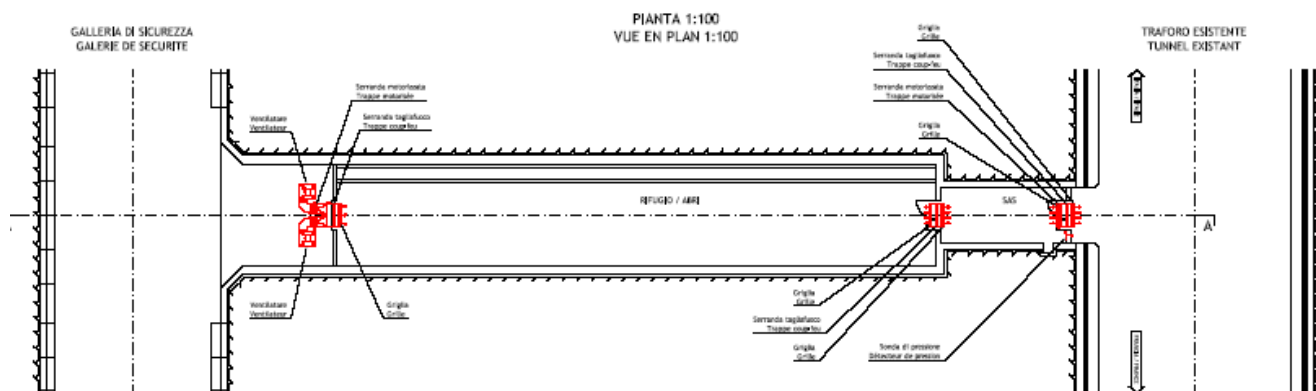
Plan d'un abri (6145.2-P-202A).
